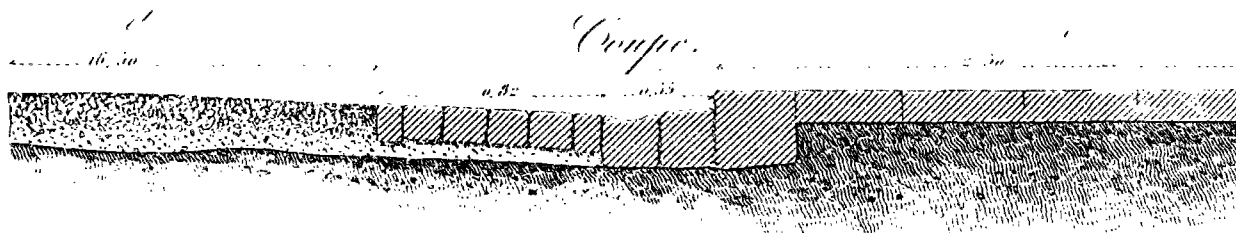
Chaussée macadamisée dans Prince's street à Edimbourg.
